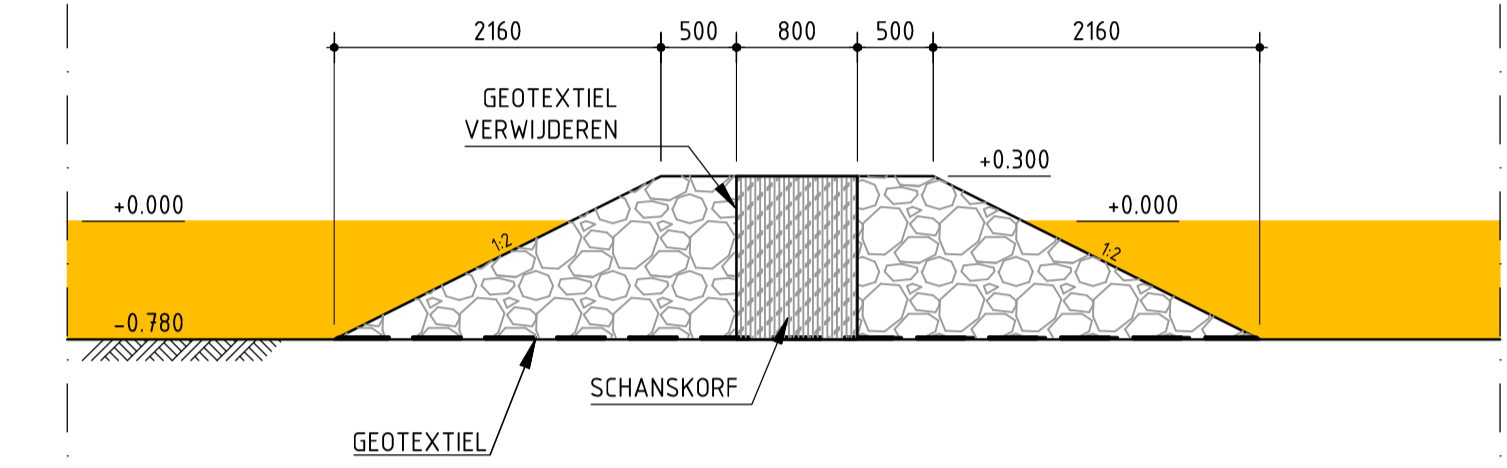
DOORSTROOMOPENING DAM 1 (5x h.o.h. 50m)
